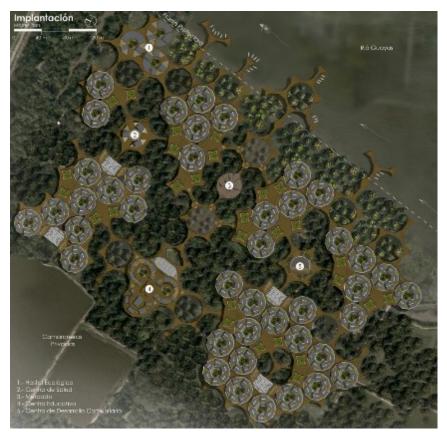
Planta de la ecoaldea Fuente: Betancourt, et al. (2017)
